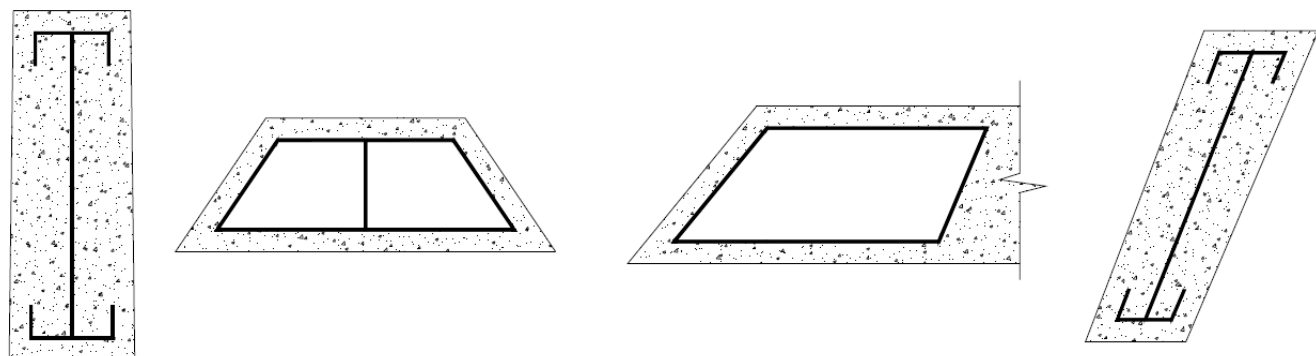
SECCIONES TIPO DEL ARCO MIXTO.
